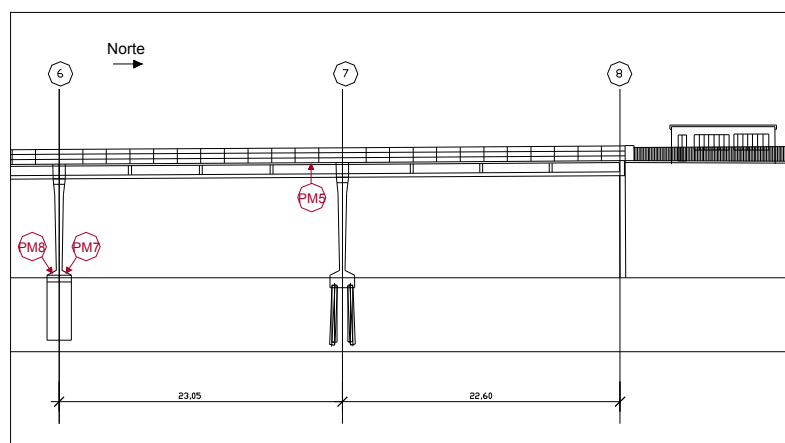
Alçado do viaduto sul de acesso à Ponte Móvel – Localização das amostras retiradas da base da parede pilar e da laje (PM5, PM7 e PM8).
